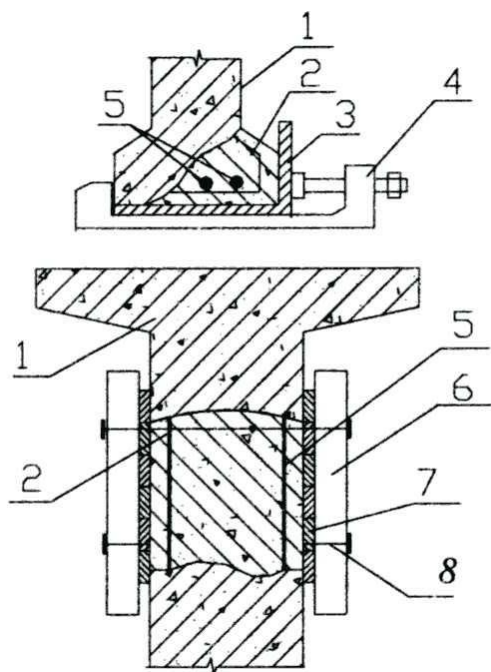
Опалубка для восстановления бетона конструкций
